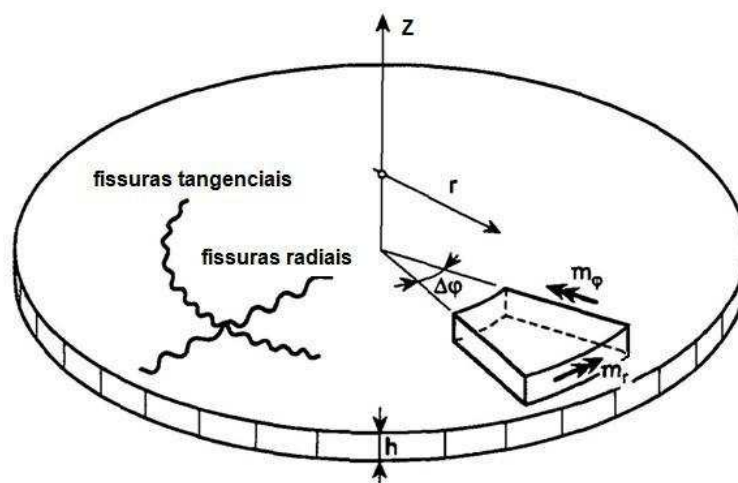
Coord. polares, forças internas e fissuras observadas em uma laje circular (MENETREY, 1994)
